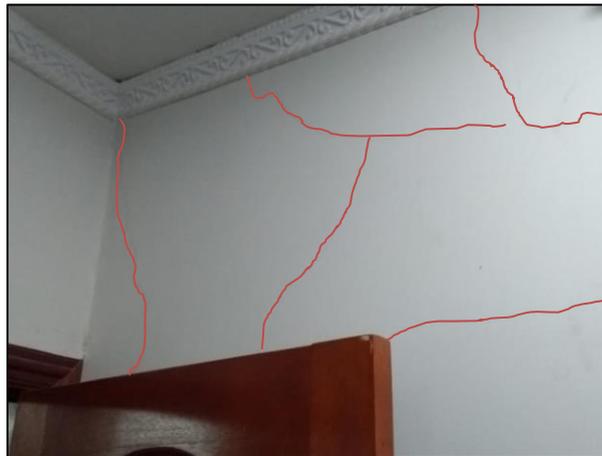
Alfajía y losa fisurada – Bloque B4 – Museo
